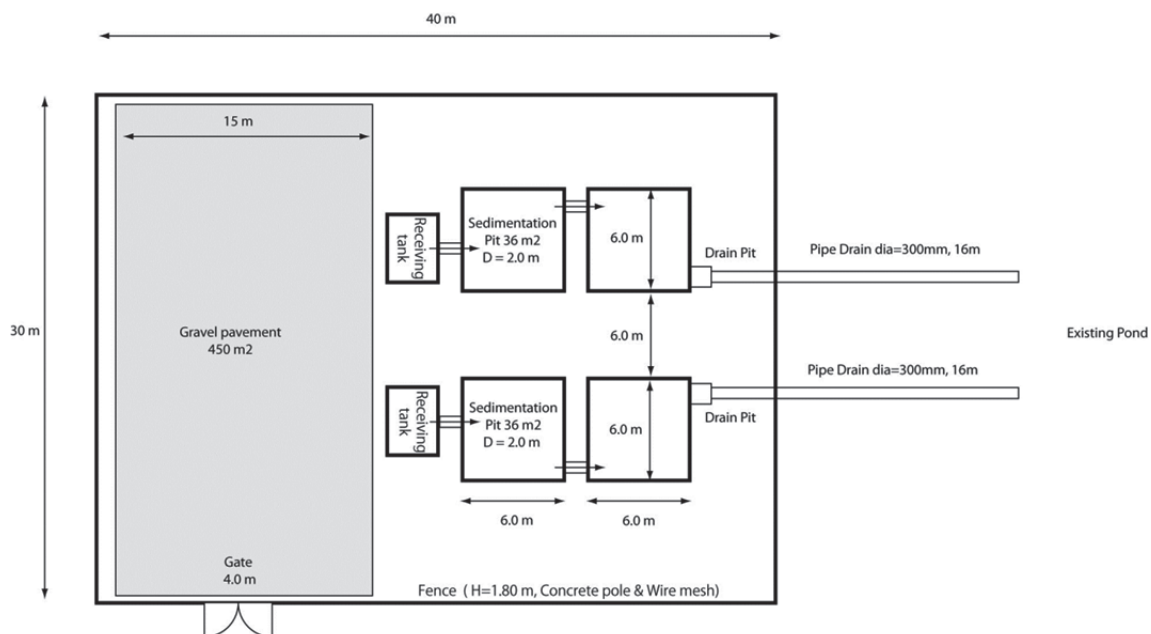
し尿浄化槽汚泥の処理施設の平面図
